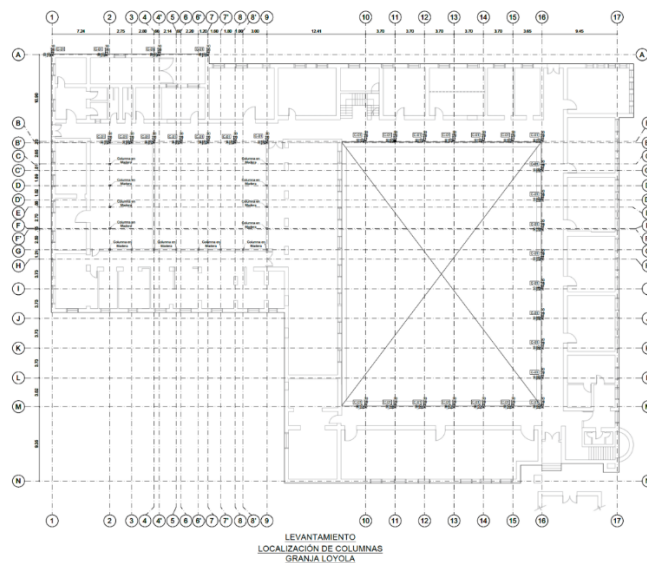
Levantamiento estructural de la Granja Loyola. Ubicación de columnas de concreto en patio central.
